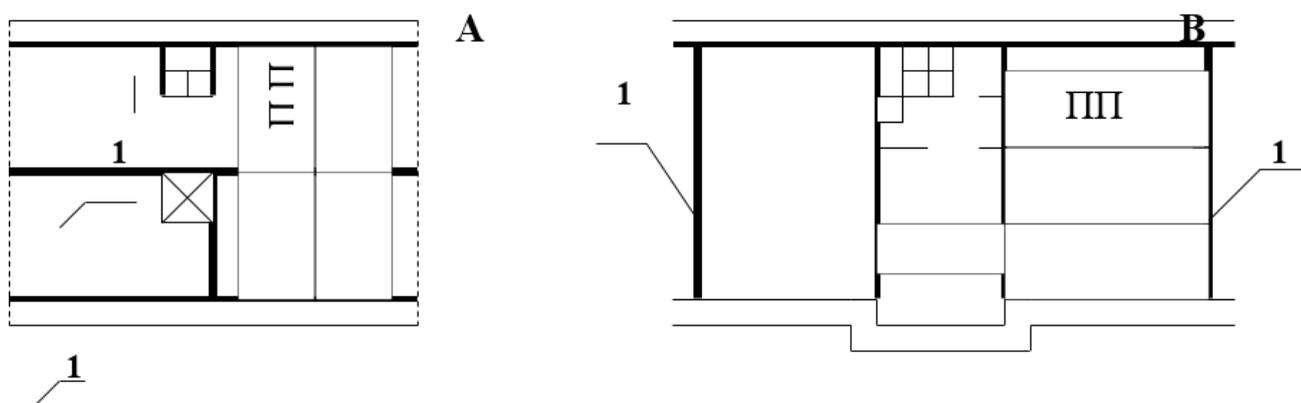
Конструктивные схемы крупнопанельных зданий: А – с продольными несущими стенами; В – с поперечными несущими стенами. 1 – несущие стены, ПП – панели перекрытий.
